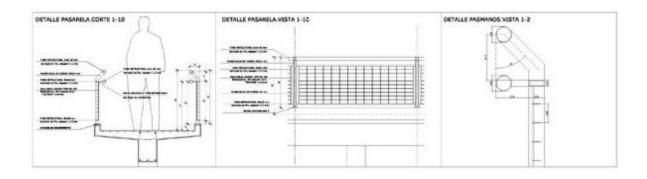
Cortes a detalle de la pasarela o puente y sus elementos (general, alzado y barandal).
